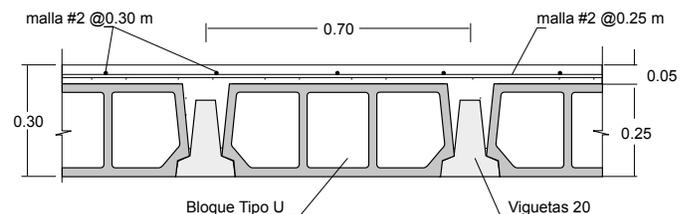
Detalle típico de entrepiso de vigueta de 20 cm con bloque tipo U
